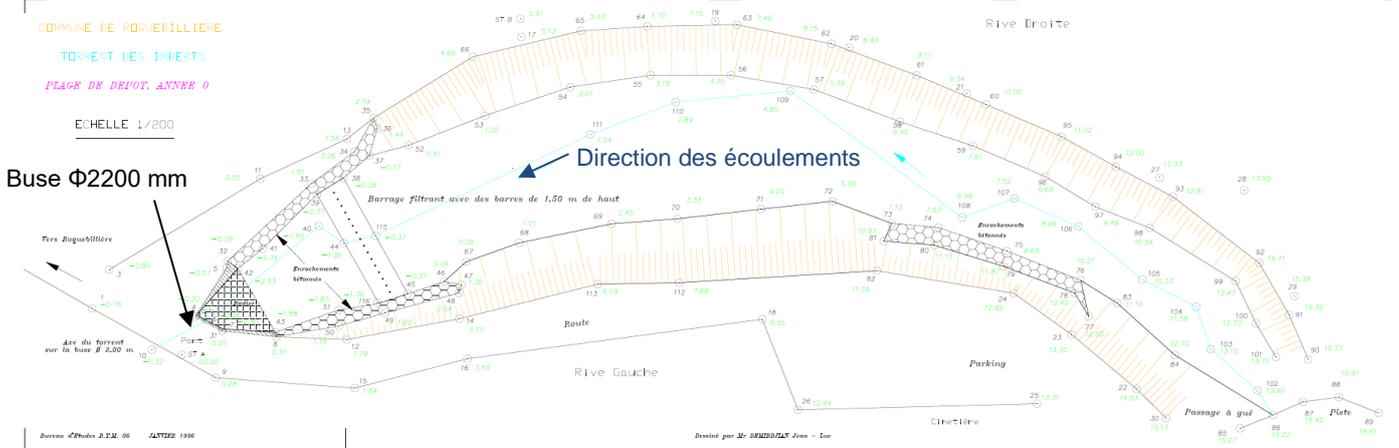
Plan masse de la plage de dépôt et de l'implantation des pieux (Source : ONF-RTM 06)
